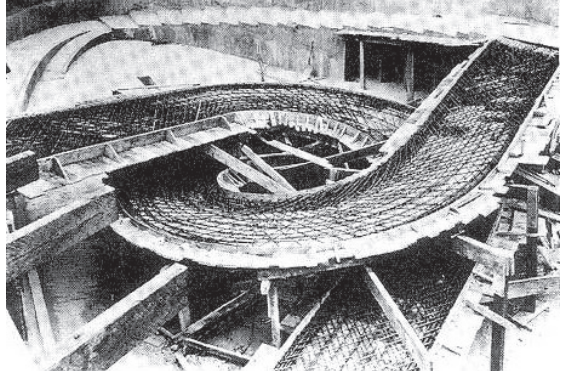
Encofrado pingüinario del Zoo de Londres. Lubetkin y Ove Arup
